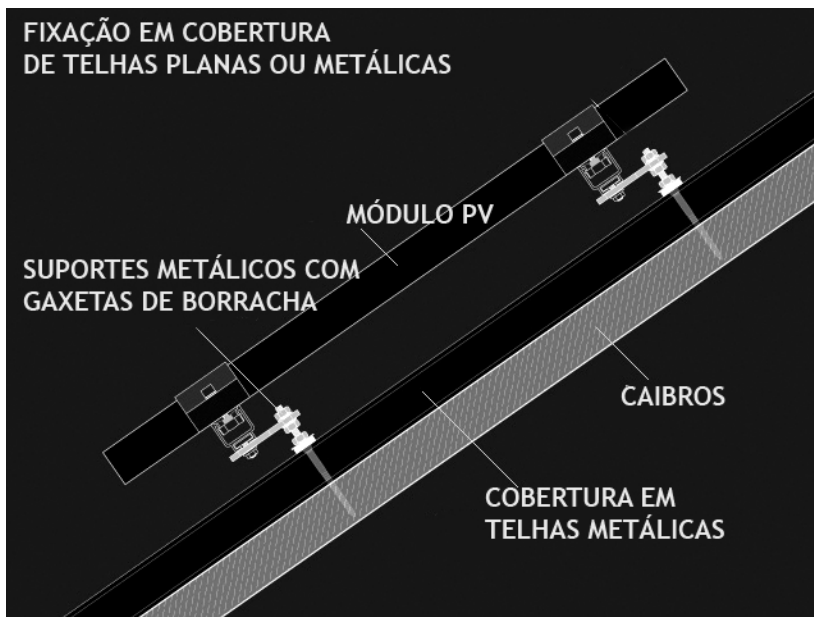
Detalhe da fixação de módulo PV em coberturas inclinadas – Telhados de chapas metálicas. Fonte: Scheletter
